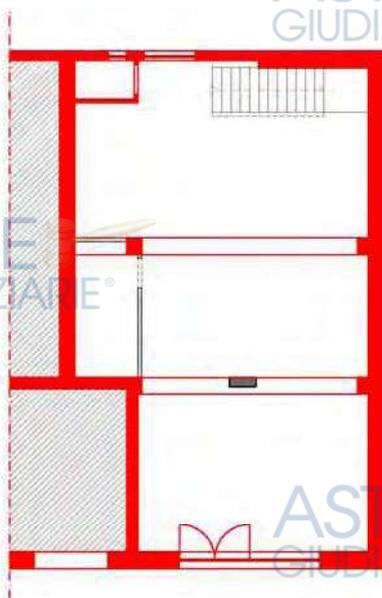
Sovrapposizione planimetria catastale (in rosso) su rilievo stato di fatto - Lotto Unico
